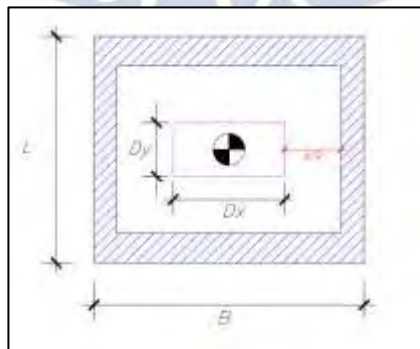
Área de la sección crítica de la cimentación por punzonamiento
